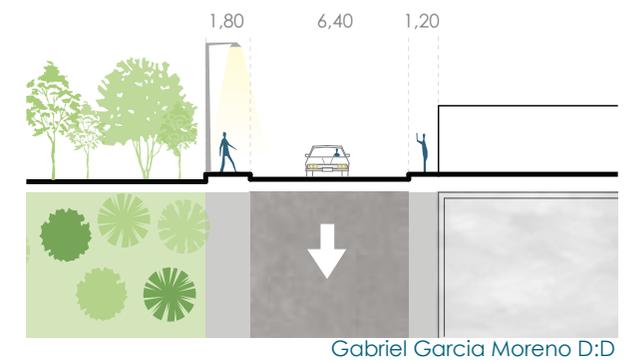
Secciones Viales. Fuente: Elaboración Propia
